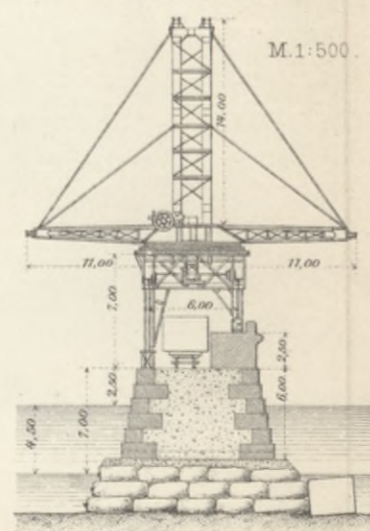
Hafendamm in Bilbao. M. 1:400.
